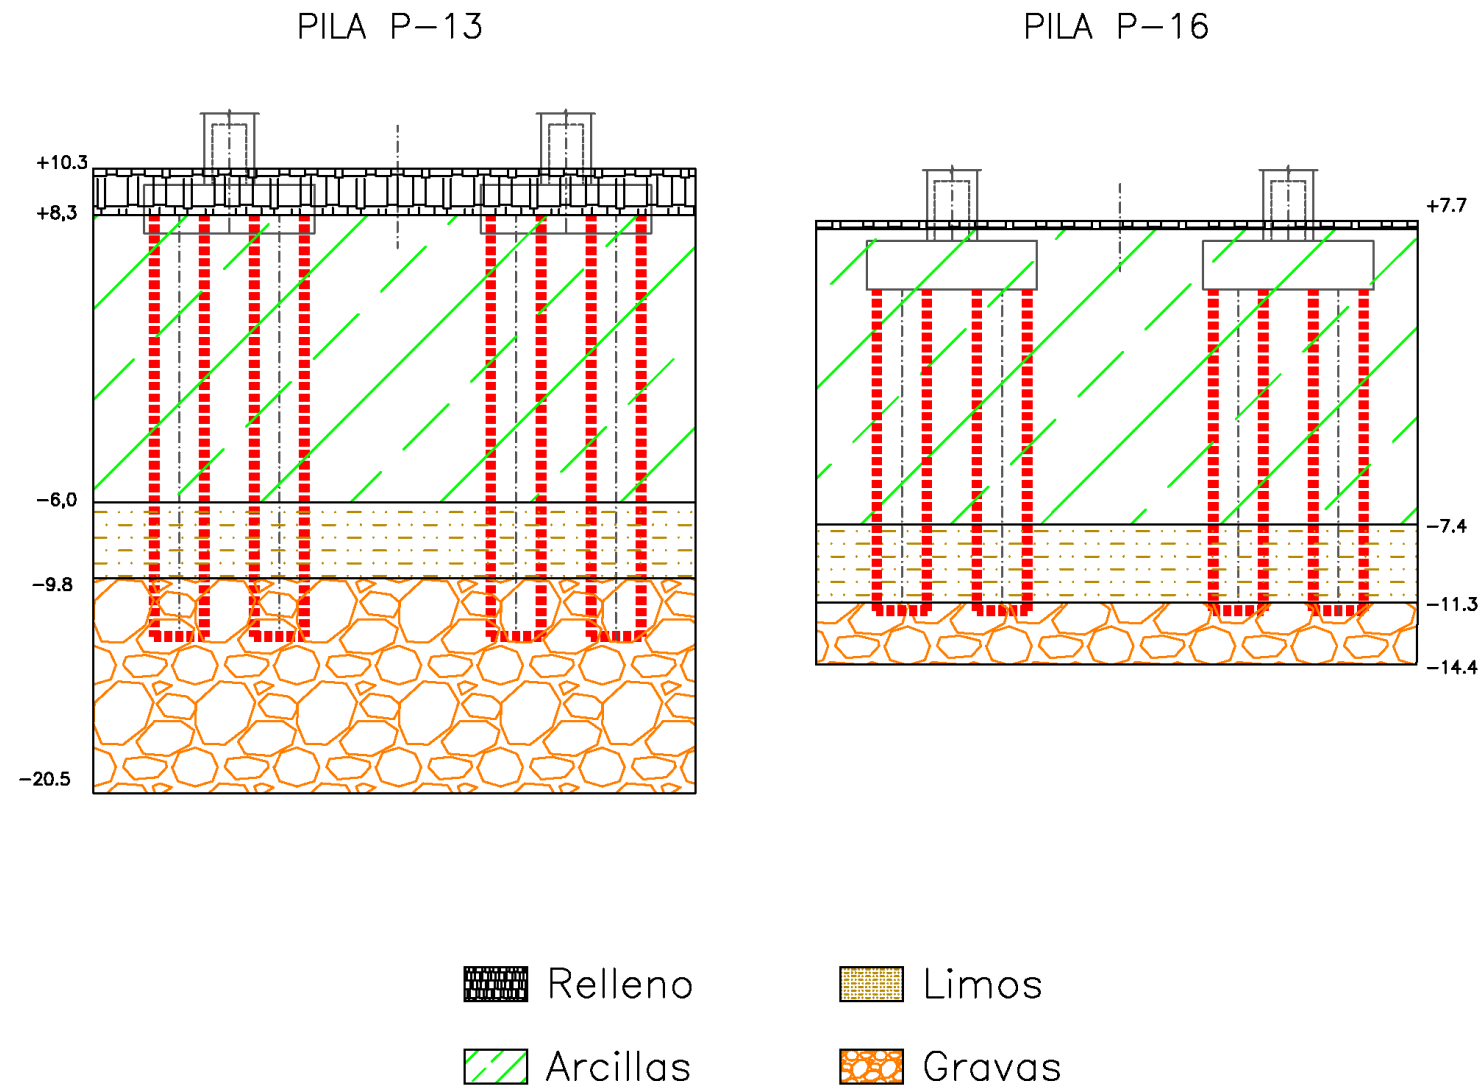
Esquema de la cimentación de las pilas P-13 y P-16
